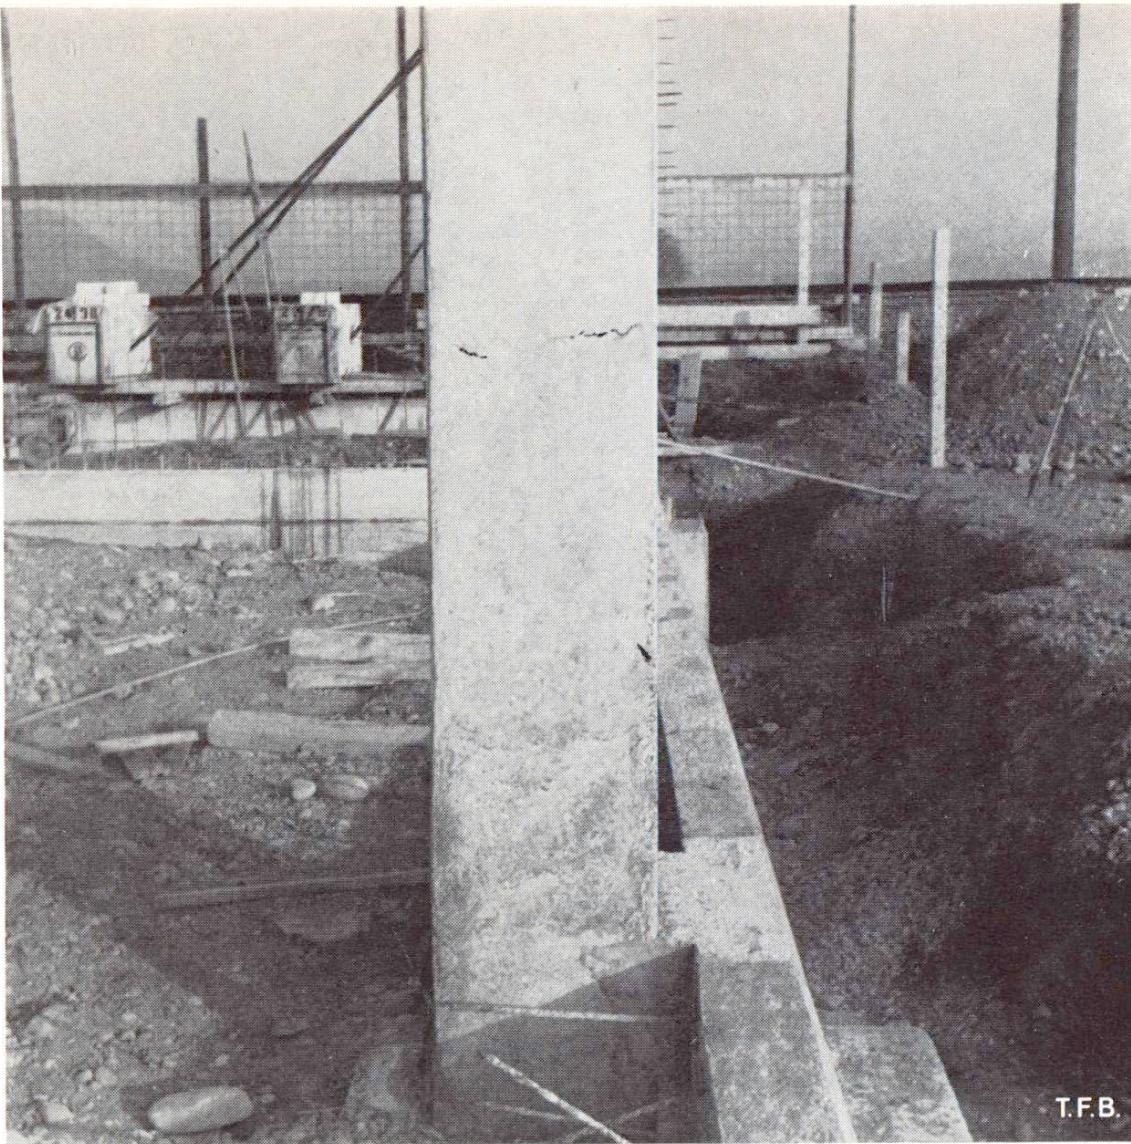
Gonflement du coffrage de la base d'un pilier avec pour conséquence des fissures de tassement.
